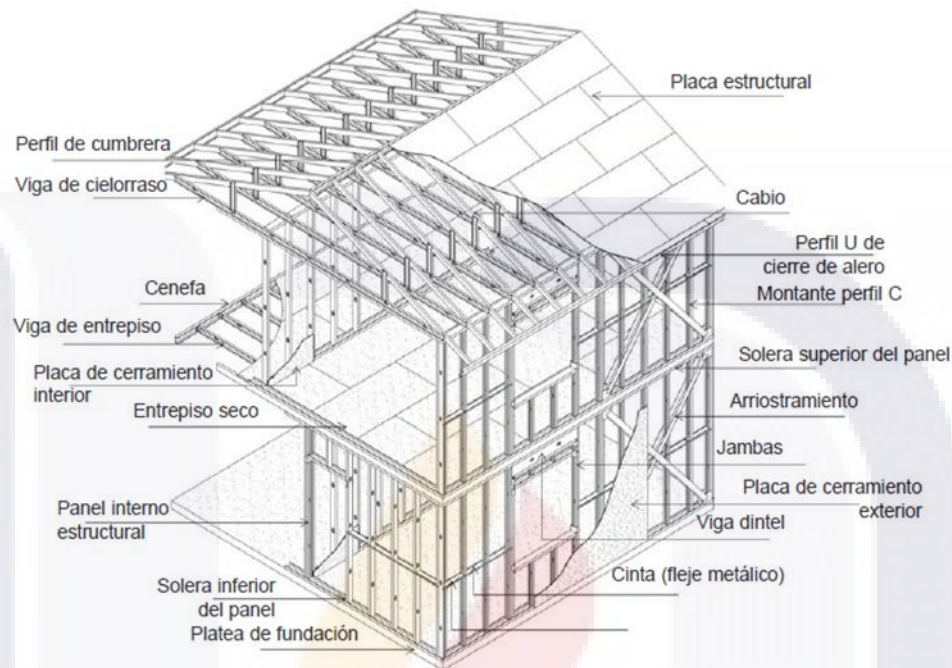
Estructuración típica de una casa de dos niveles utilizando elementos de acero rolado en frío de pared delgada. (Sarmanho, 2007).
